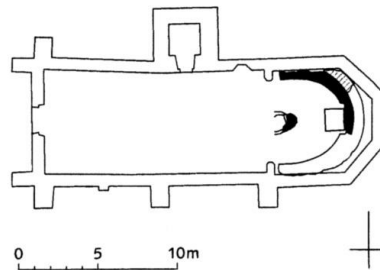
Grundriss von S. Pietro in Cembra mit archäologisch nachgewiesenen Strukturen.
